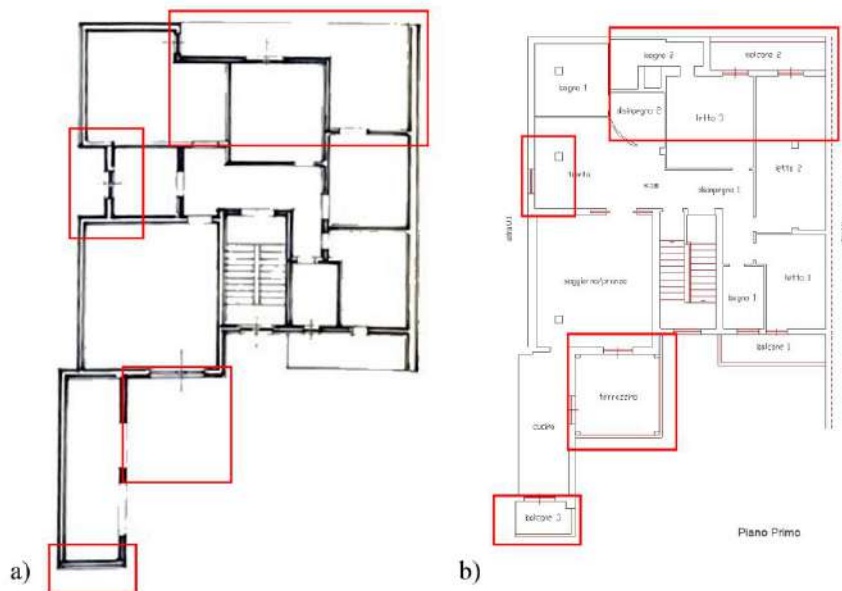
Difformità primo piano: a) Planimetria del titolo abilitativo; b) Planimetria stato di fatto
